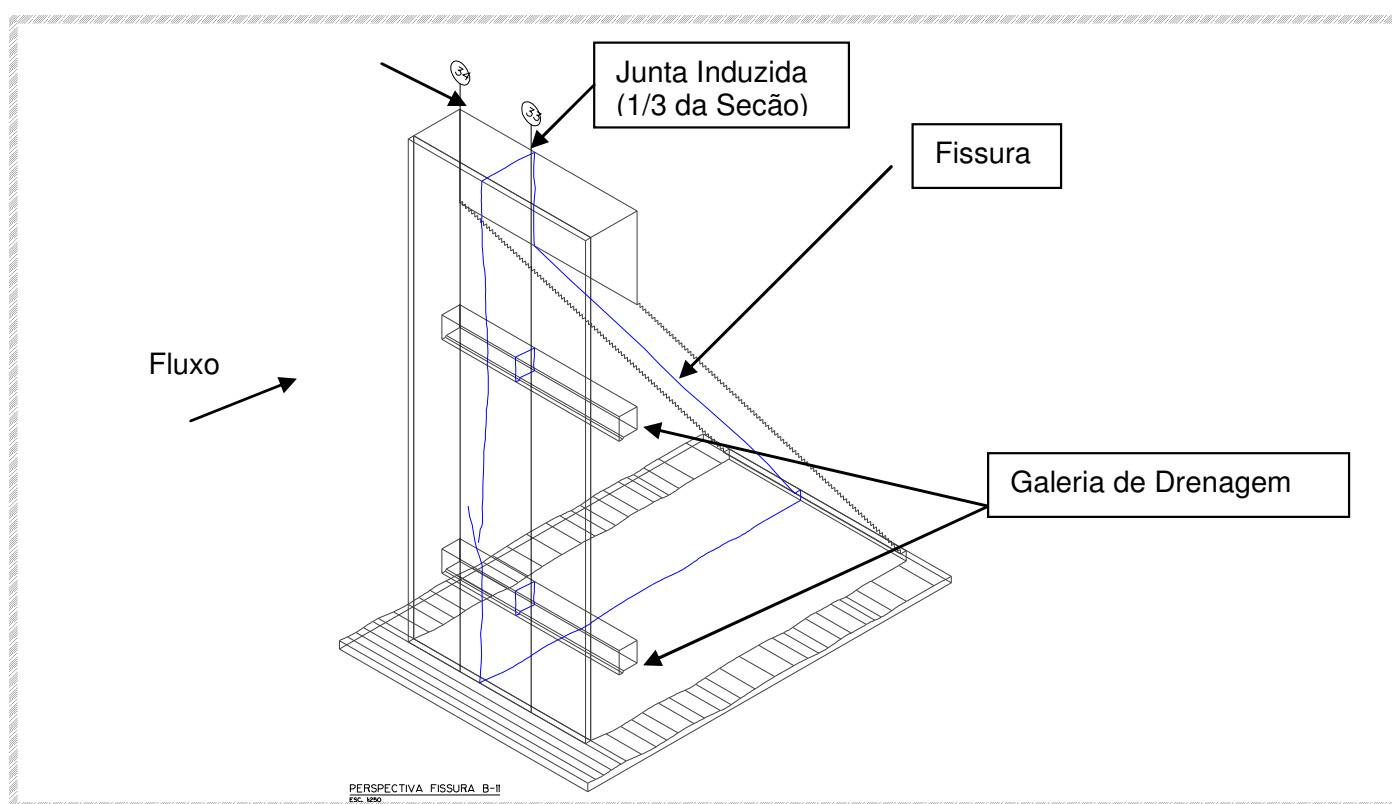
2: Tridimensional esquemático da fissura na seção da barragem do B11 (Soares, 2005).
